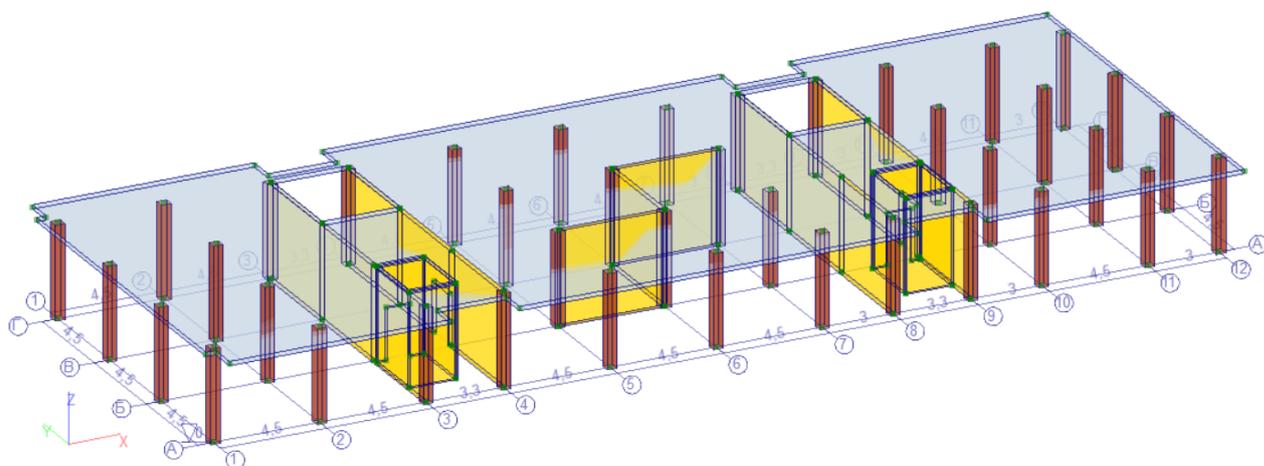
Укрупненная схема междуэтажного перекрытия
